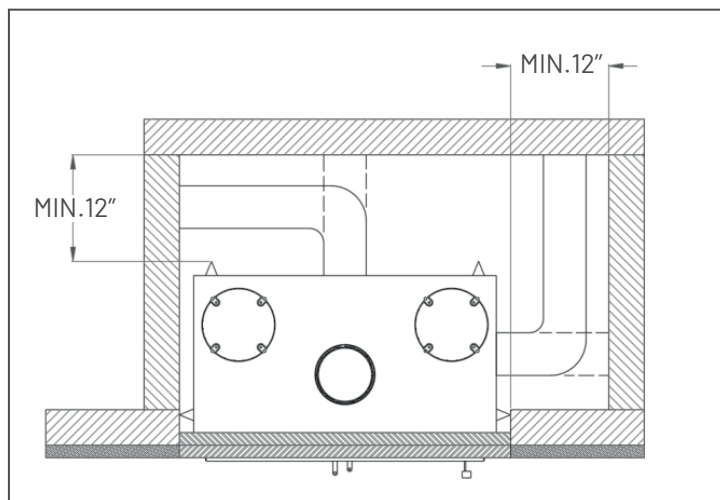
Espace requis pour installer le système à air chaud pulsé et/ou la prise d'air extérieure
